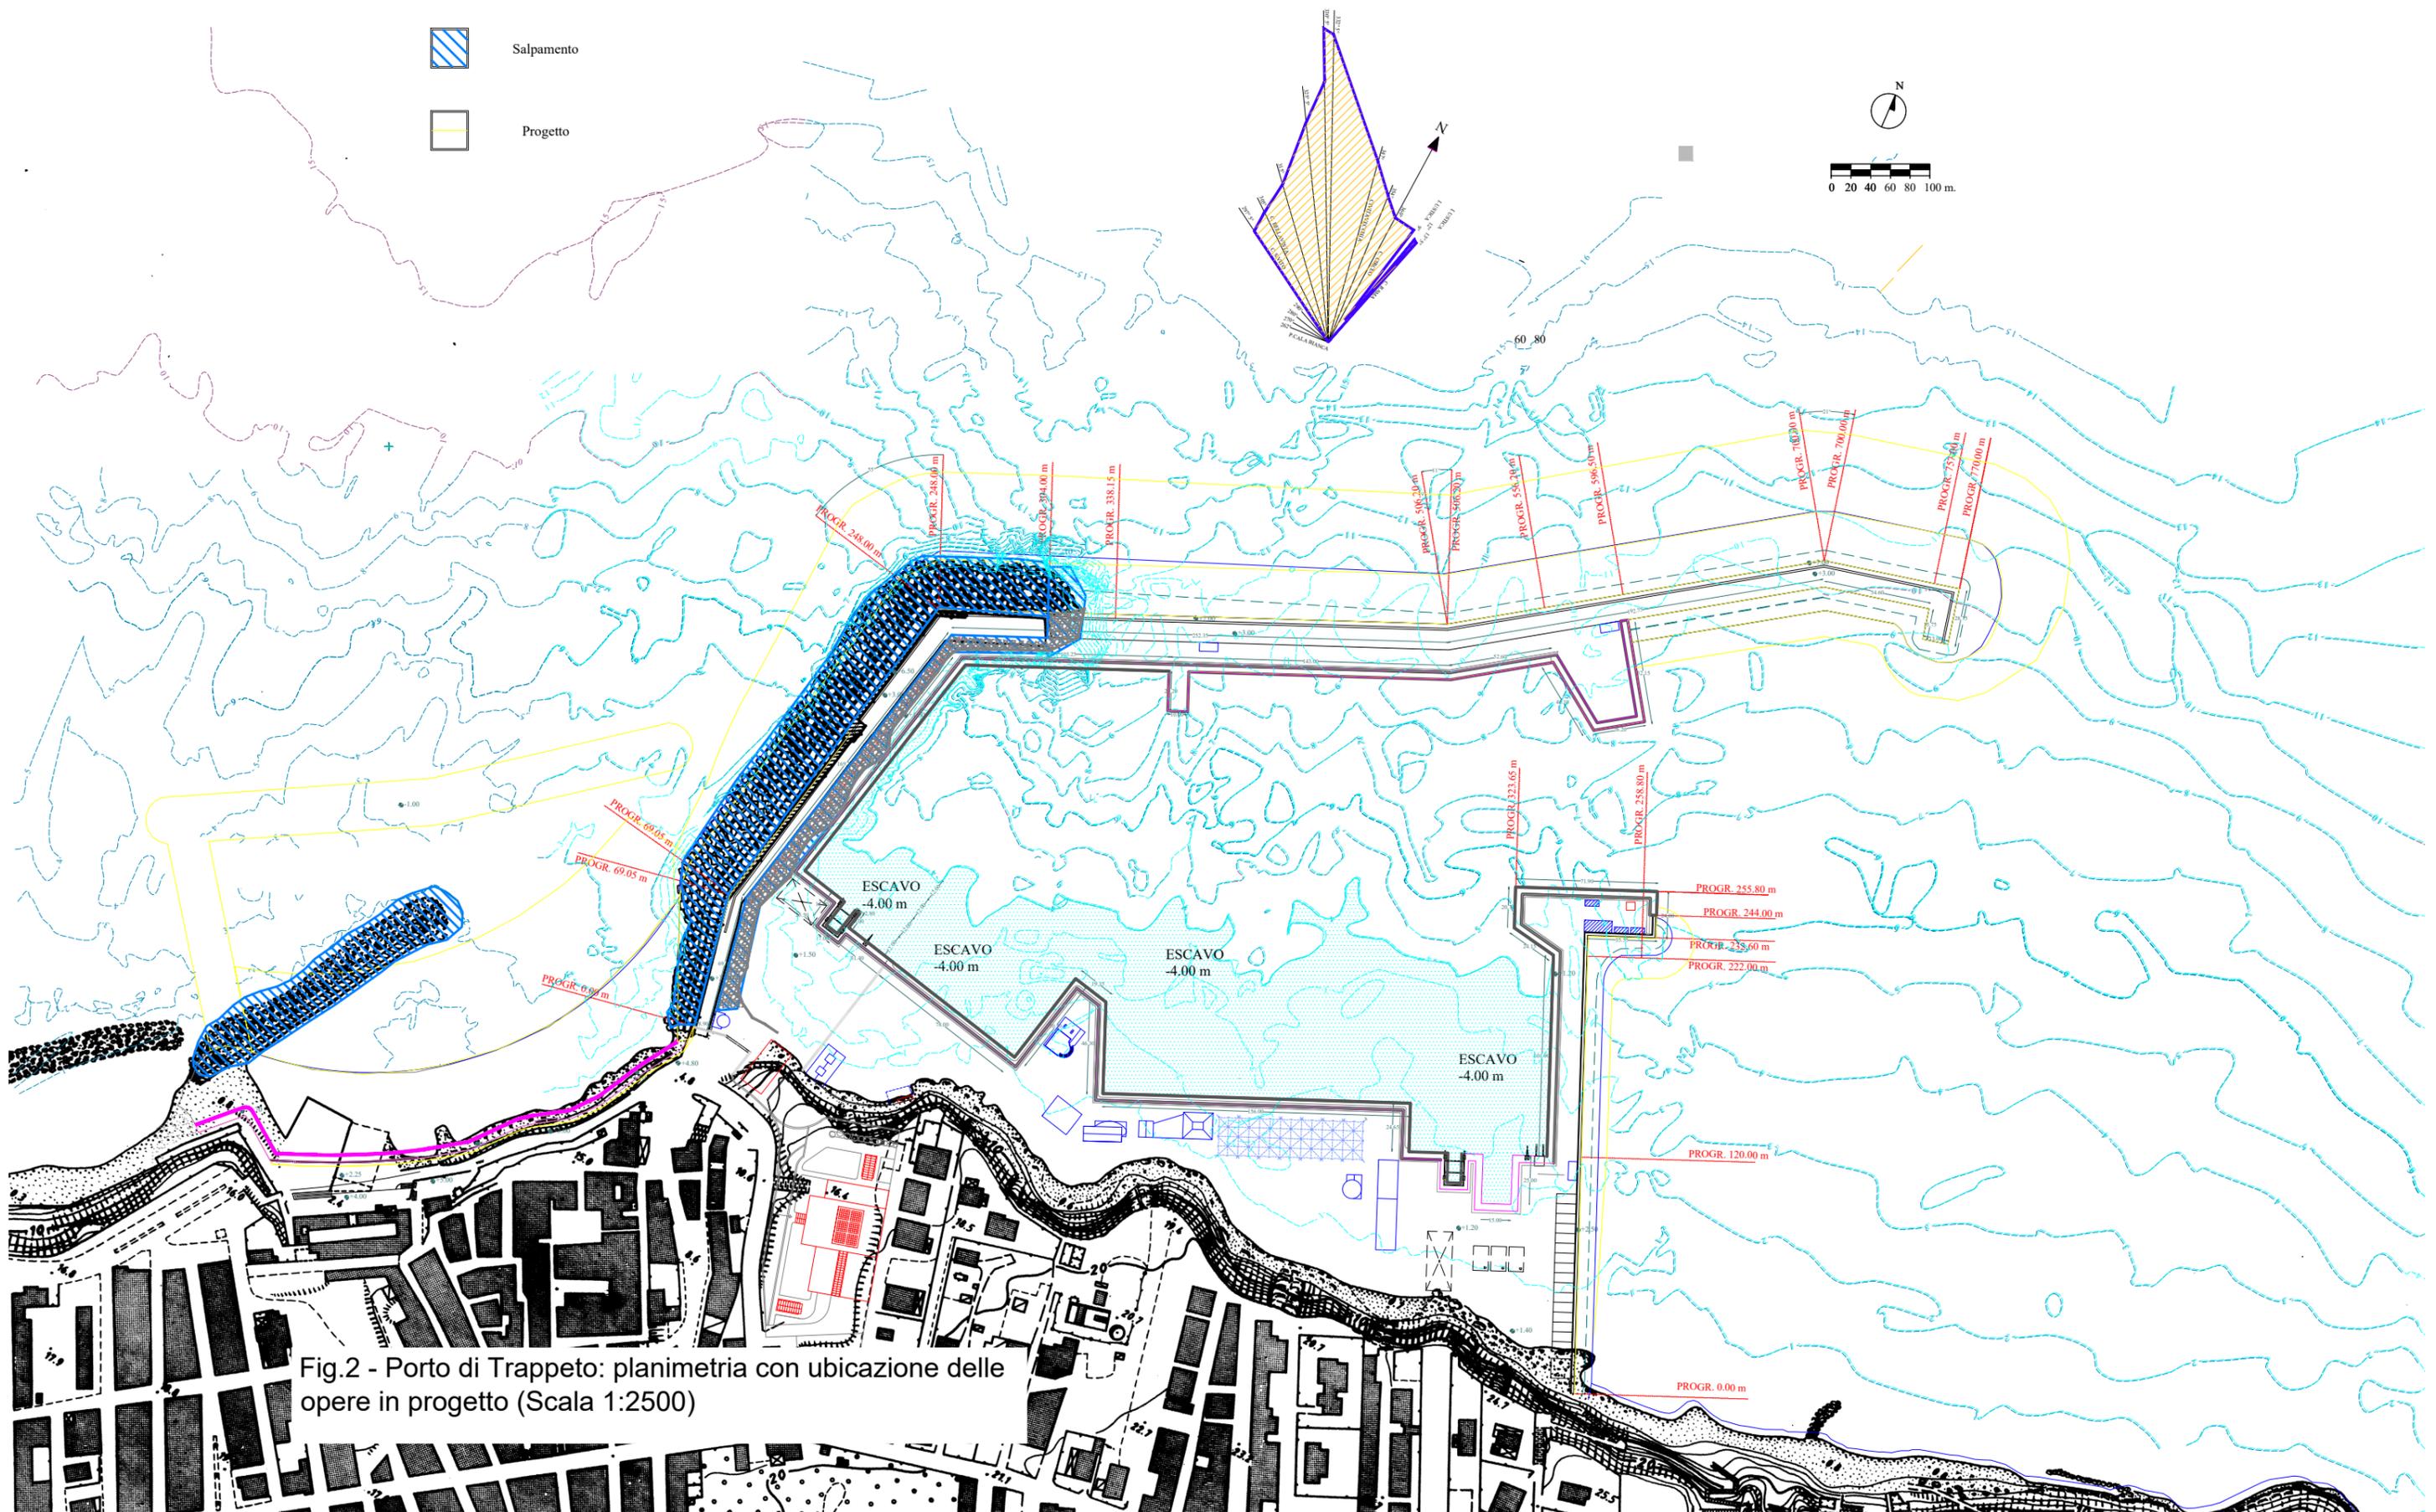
Porto di Trappeto: planimetria con ubicazione delle opere in progetto (Scala 1:2500)
